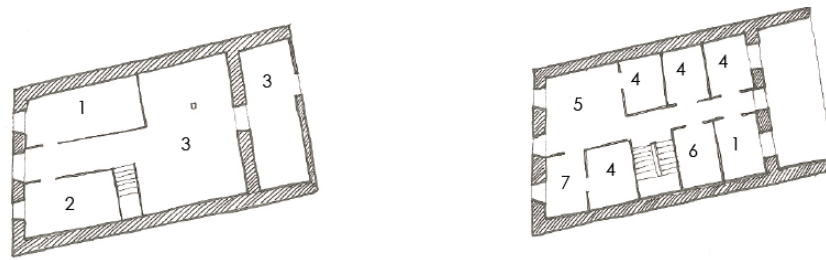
Planta baja y planta alta del caso de estudio 4 – Tipología 2
